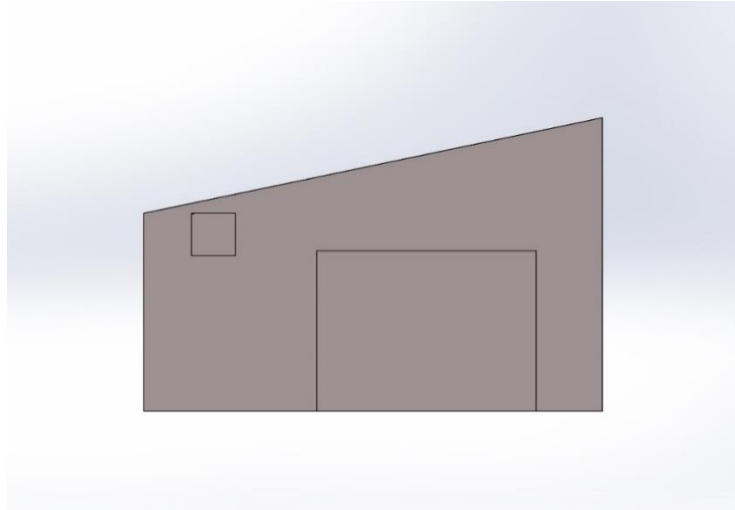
Vue de d'arrière du bâtiment sur SolidWorks
